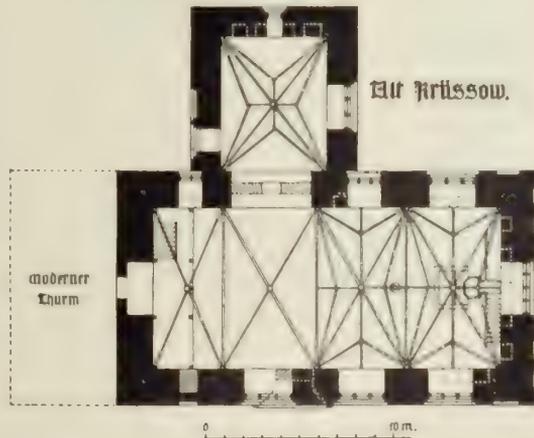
Alt-Krüssow. Grundriß der Kirche.
